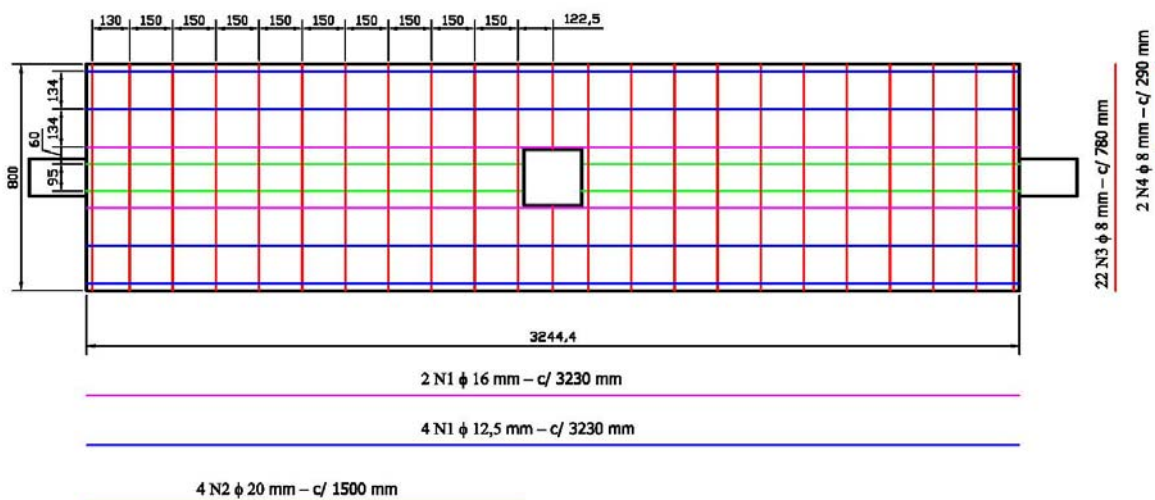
Projeto de armação da laje do Modelo 2.
